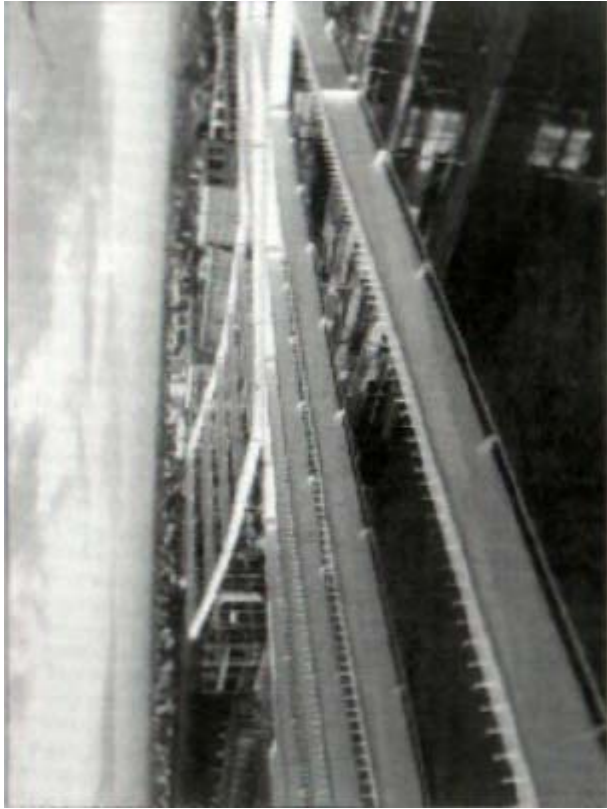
Vista de la cubierta de techo del multiplex de La Lucchina.
